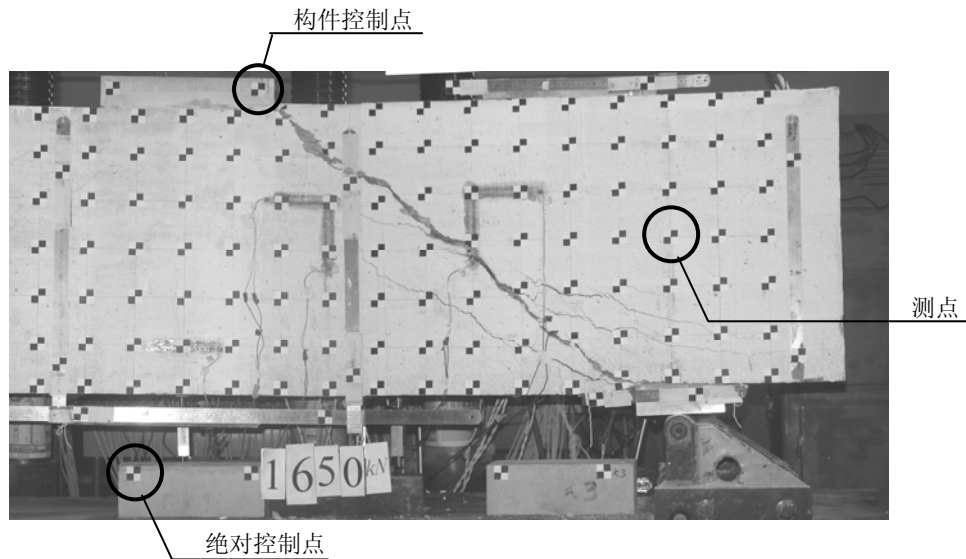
钢筋混凝土梁剪切破坏试验中数字摄影测量的标志点布置
